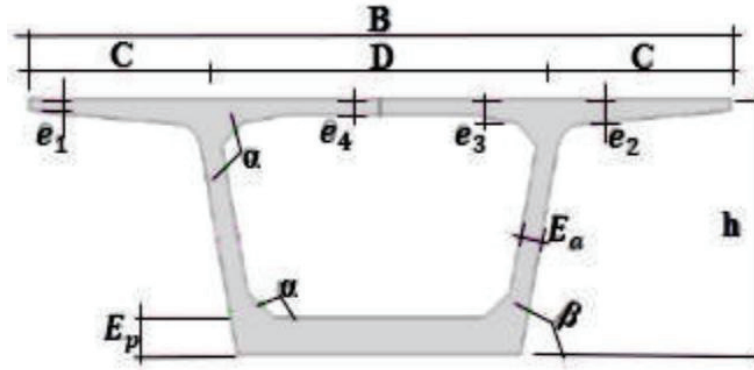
Les composants du voussoir (poutre-caisson).
